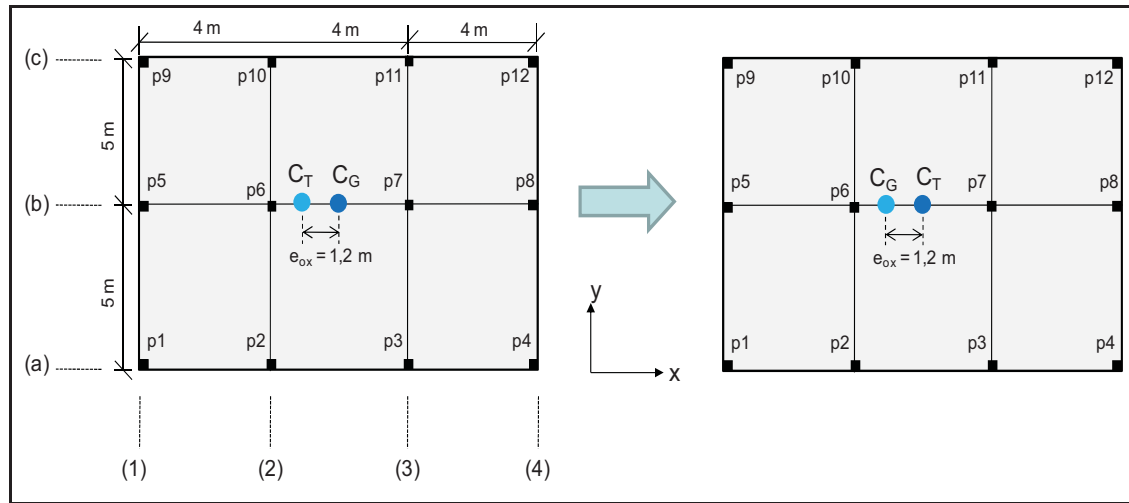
Vue en plan avec les files de contreventement de la structure
